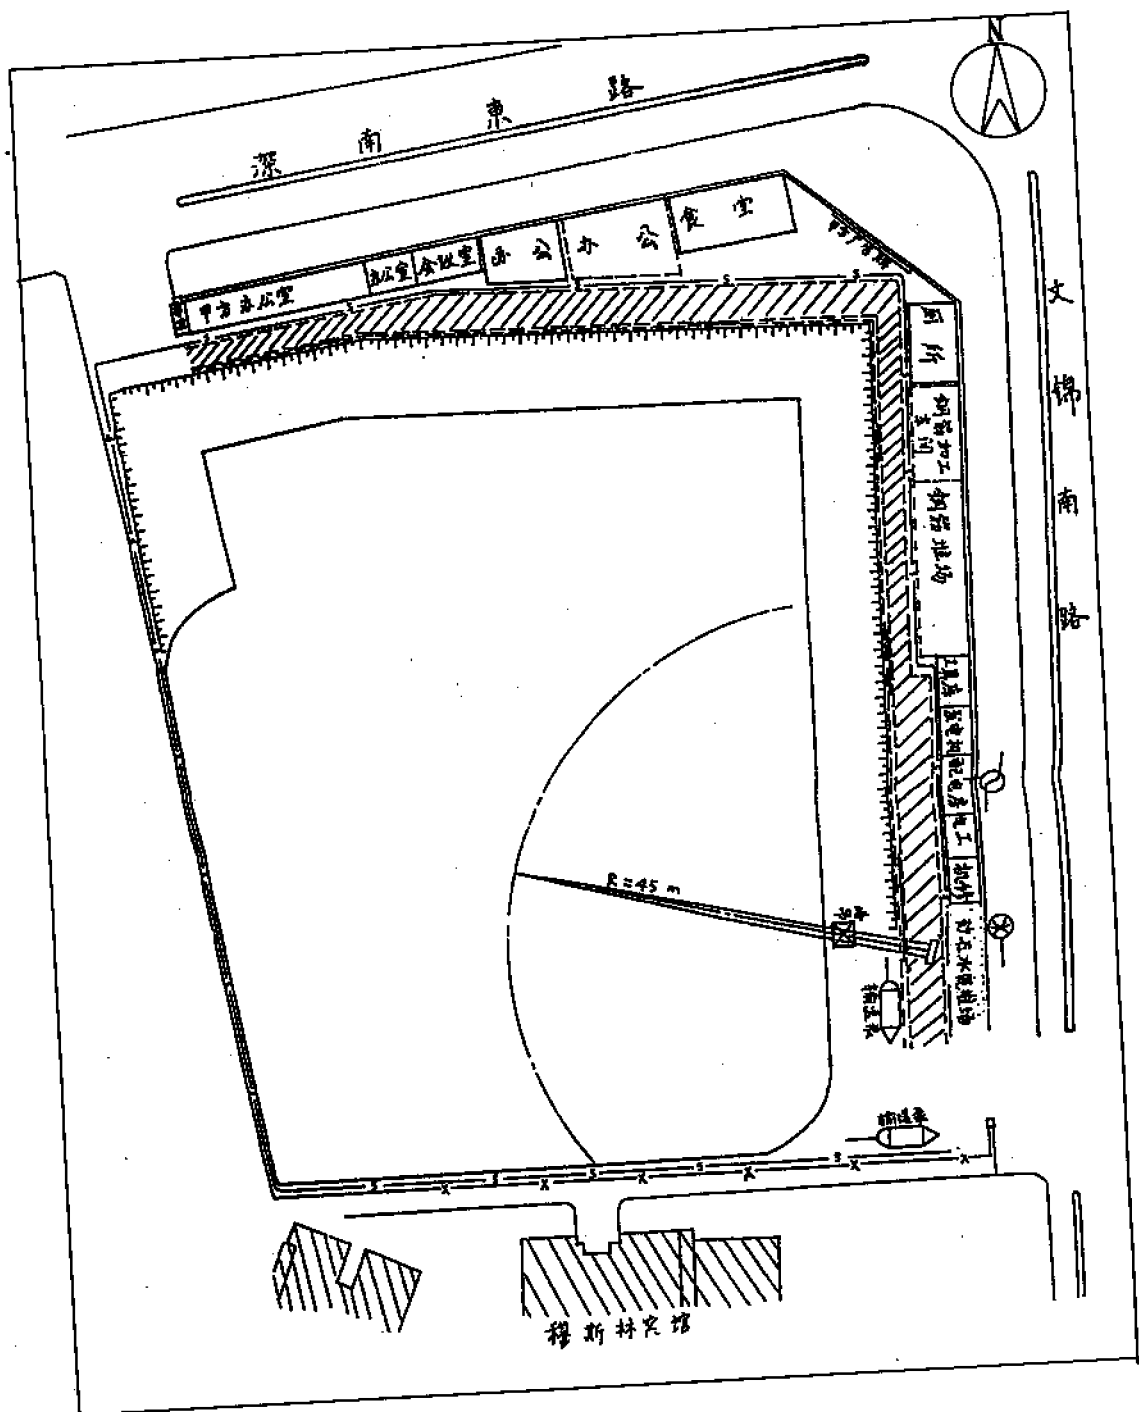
(41) 贤成大厦地下室裙房工程施工平面布置图
